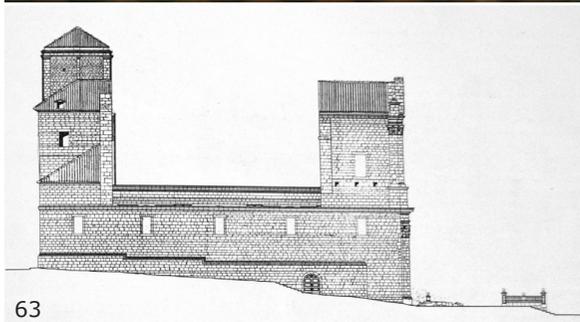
Alzado S.E. Estado previo. (*Arq.* nº273, p.63)
